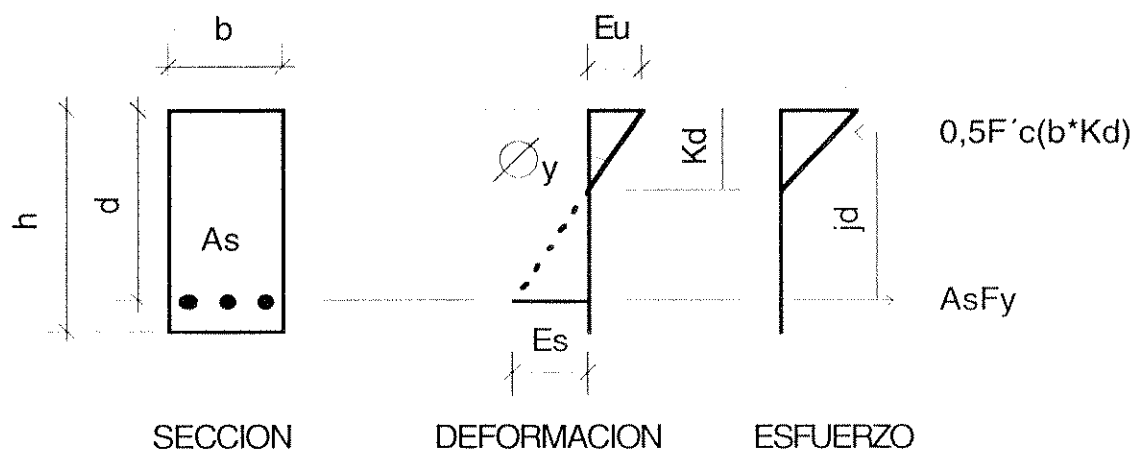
SECCION DE UNA VIGA SIMPLEMENTE REFORZADA A FLEXION A LA PRIMERA CEDENCIA.
